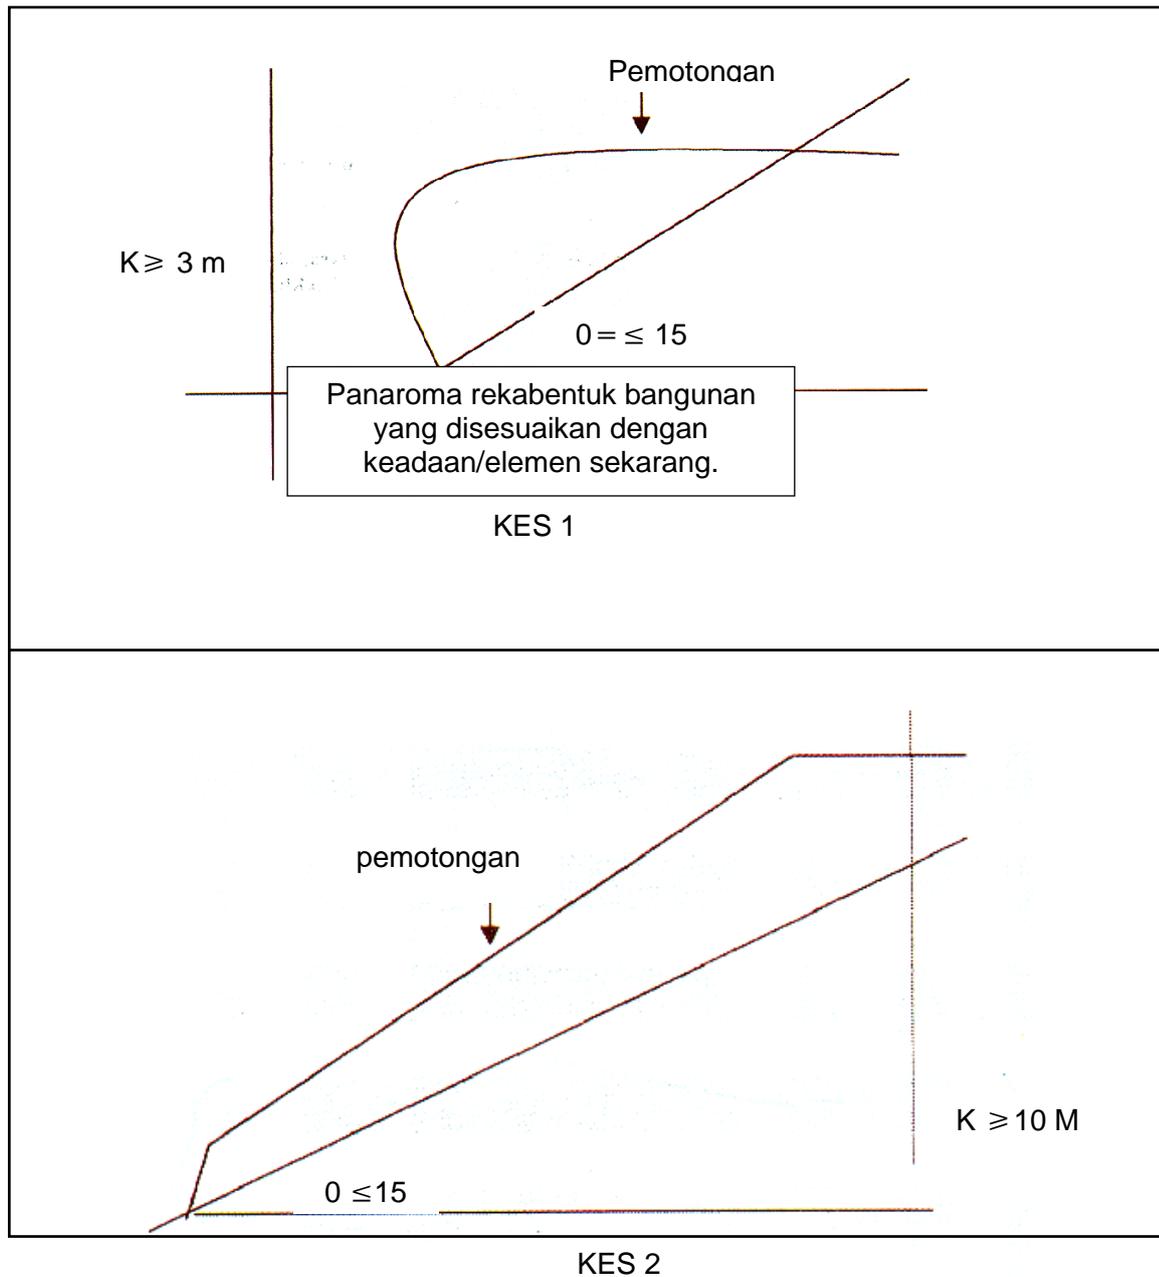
Orientasi Bangunan Disesuaikan Dengan Vista Semulajadi
